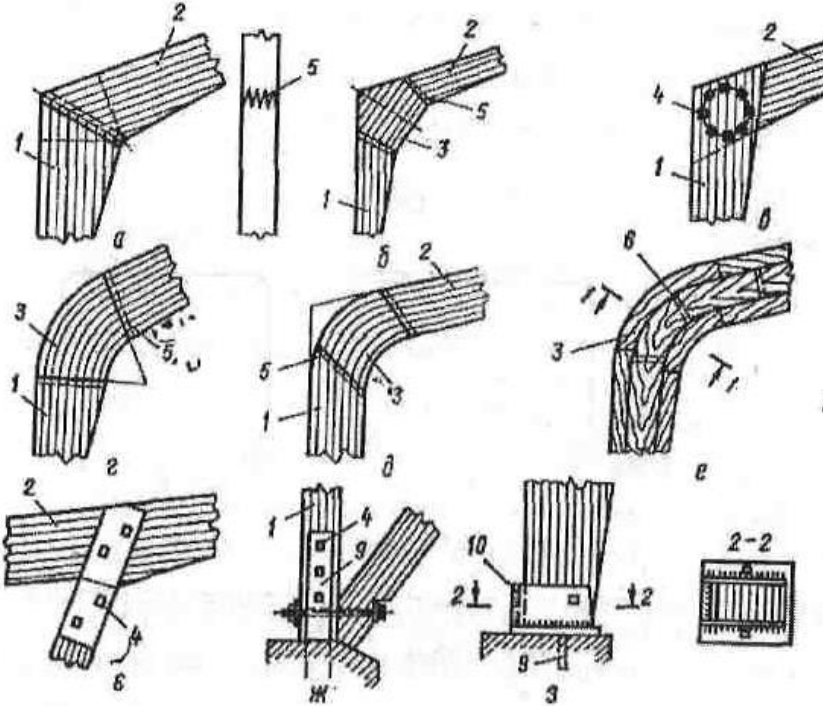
Вузли тришарнірних рам: а– карнизний з прямолінійних елементів на зубчатому стику; б – те саме, з клеєною вставкою; в – те ж саме на сталевих нагелях; г, д – карнизні вузли гнукклеєної рами з вставками; є – те саме, дощатофанерної рами; є – кріплення підкоса до ригеля; ж, з– опирання рам на фундаменти; 1 – стояк; 2 – ригель; 3 – вставки; 4 – болти; 5 – зубчатий стик; 6 – ребра жорсткості; 7 – пояс; 8 – фанерні стінка; 9 – анкери; 10 – башмак
